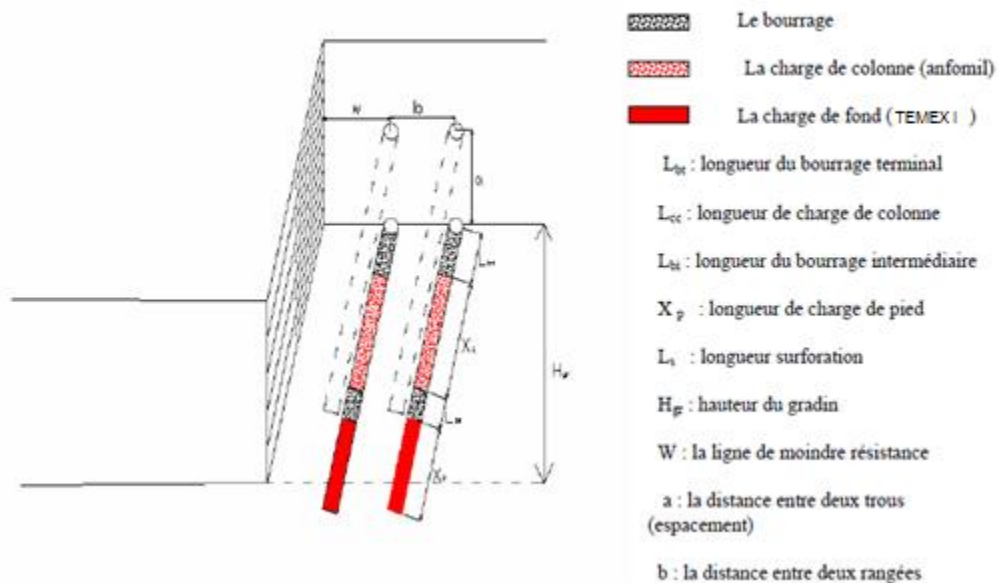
coupe d'un plan de tir avec distribution des charges.
